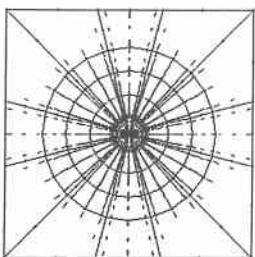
1軸ひび割れ発生規準のひび割れ性状 図-4 2軸ひび割れ発生規準のひび割れ性状
